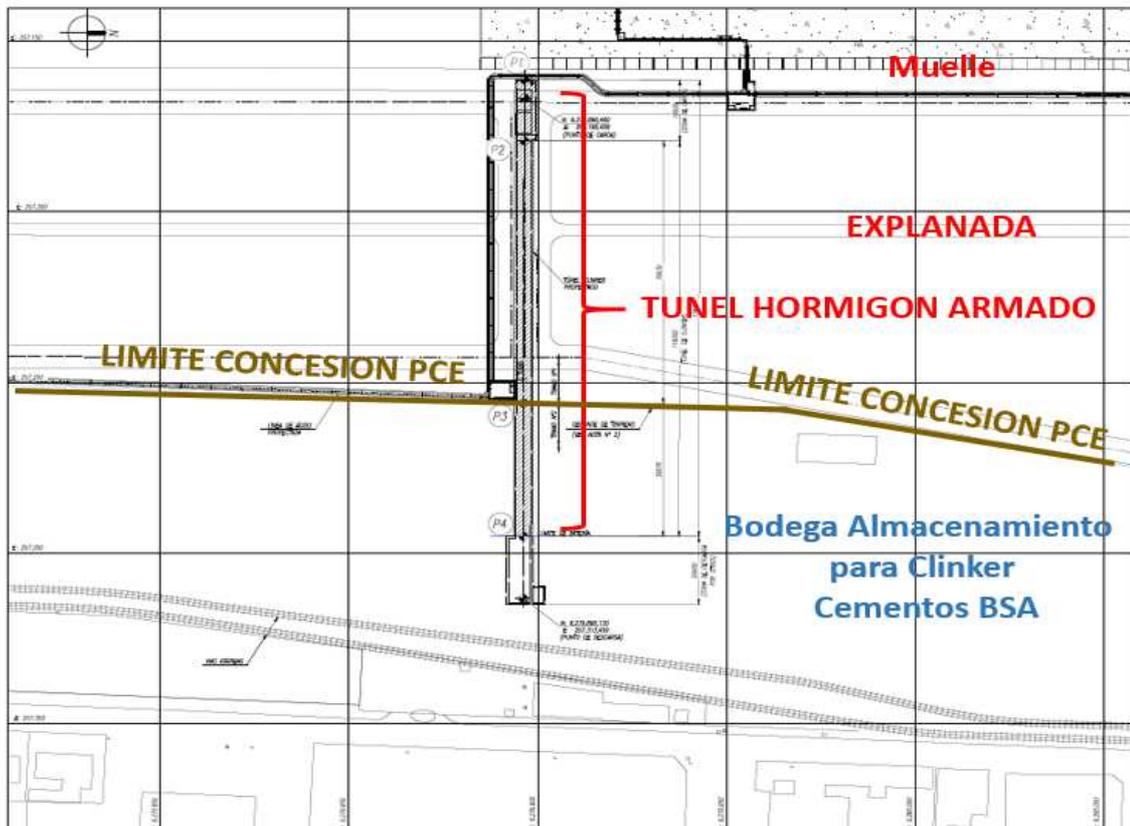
LAY OUT DE TUNEL PARA DESCARGA DE CLINKER
